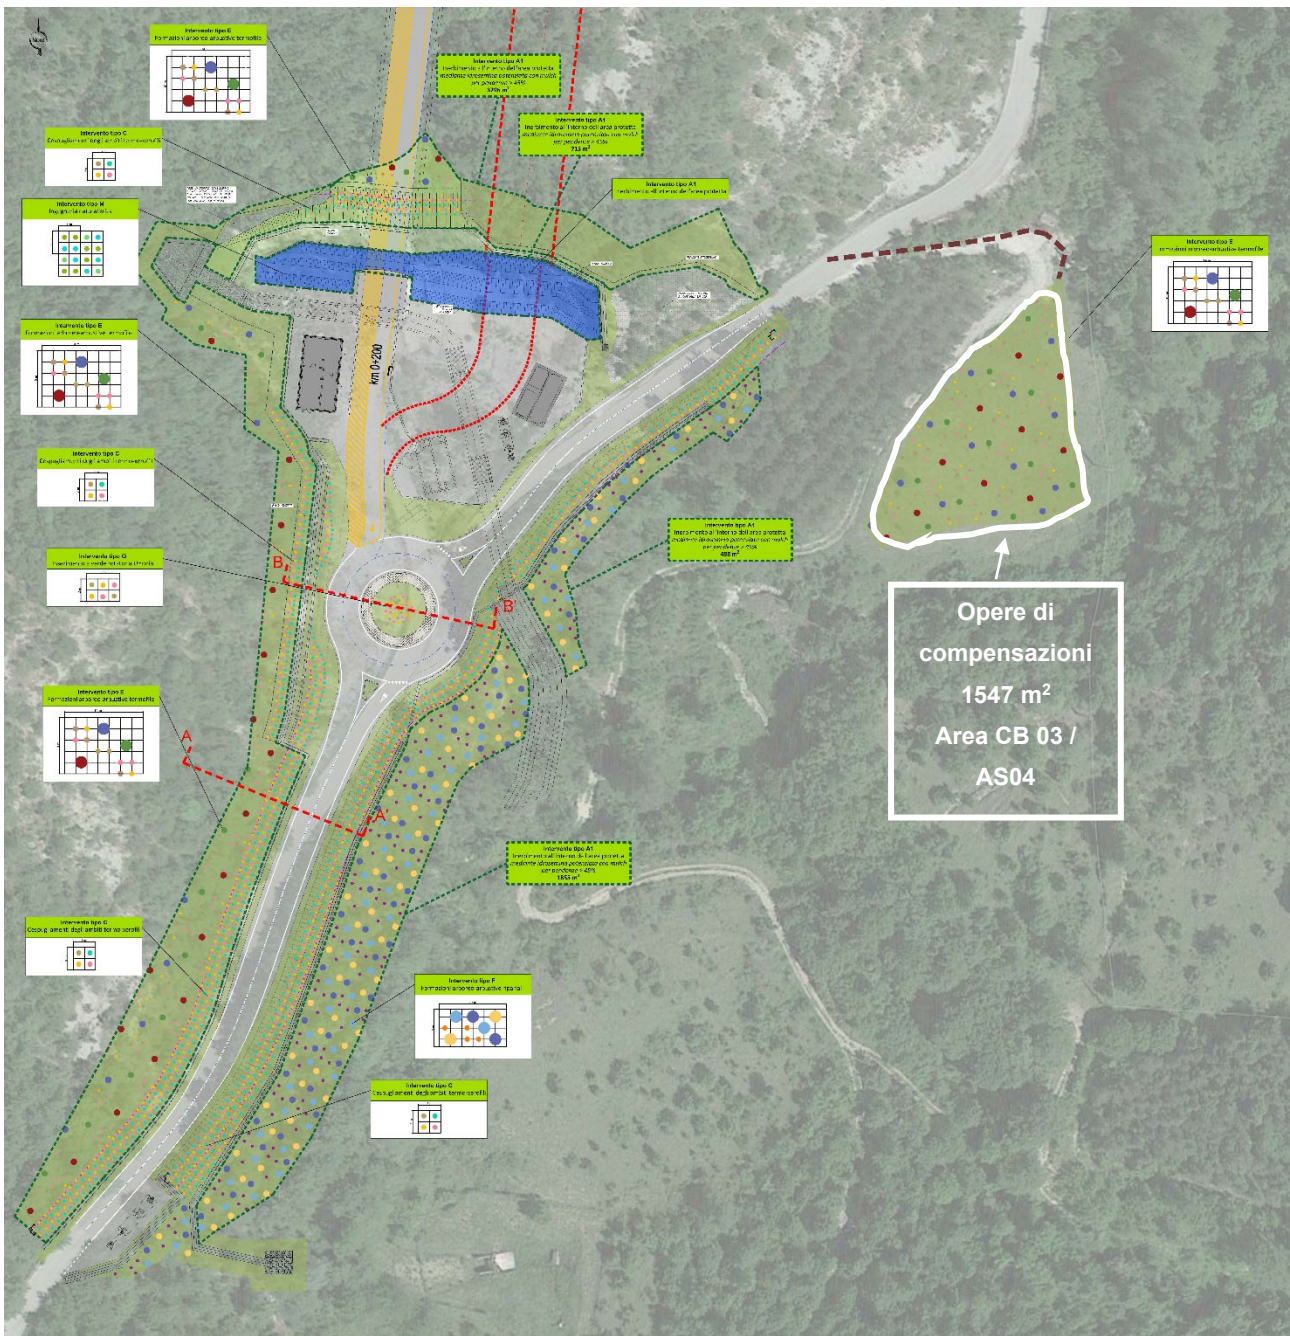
Localizzazione delle opere di compensazione forestale rispetto alla nuova infrastruttura di progetto (estratto tavole di progetto T00IA01AMBPP01A – Planimetria Opere a Verde – lato Umbria)
